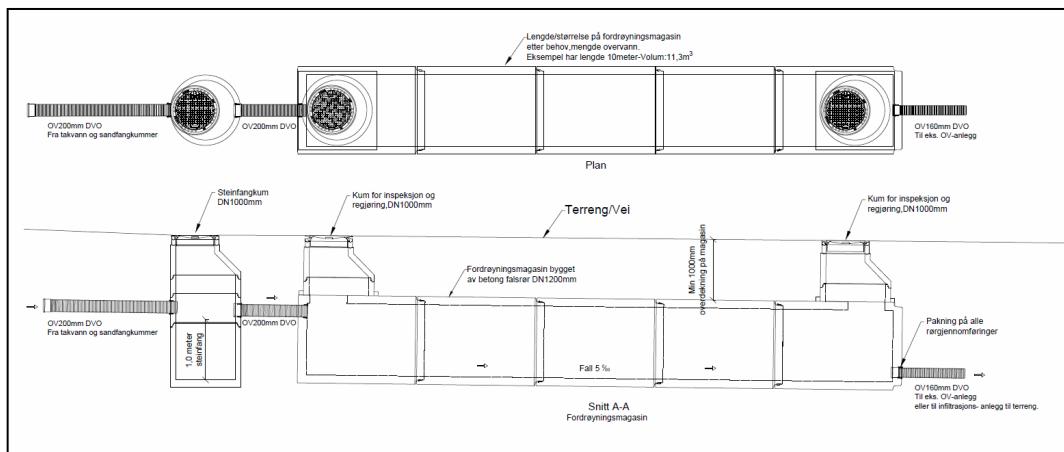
Prefabrikkert fordrøyningsanlegg i betong.
